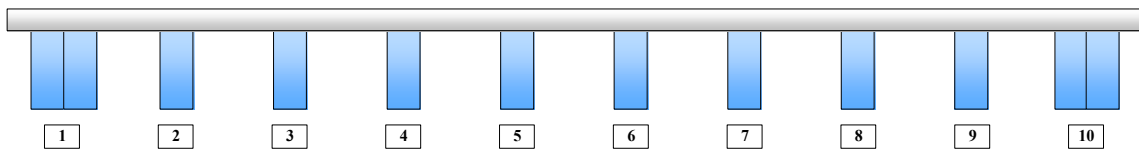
Ouvrage n°2 à poutres rectangulaires et rives jumelées
